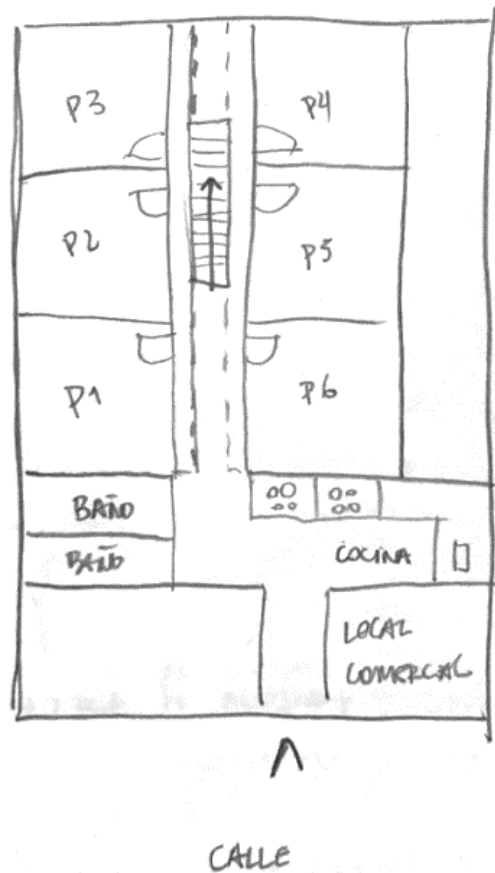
Planta esquemática realizada en terreno. Fuente: Elaboración propia
